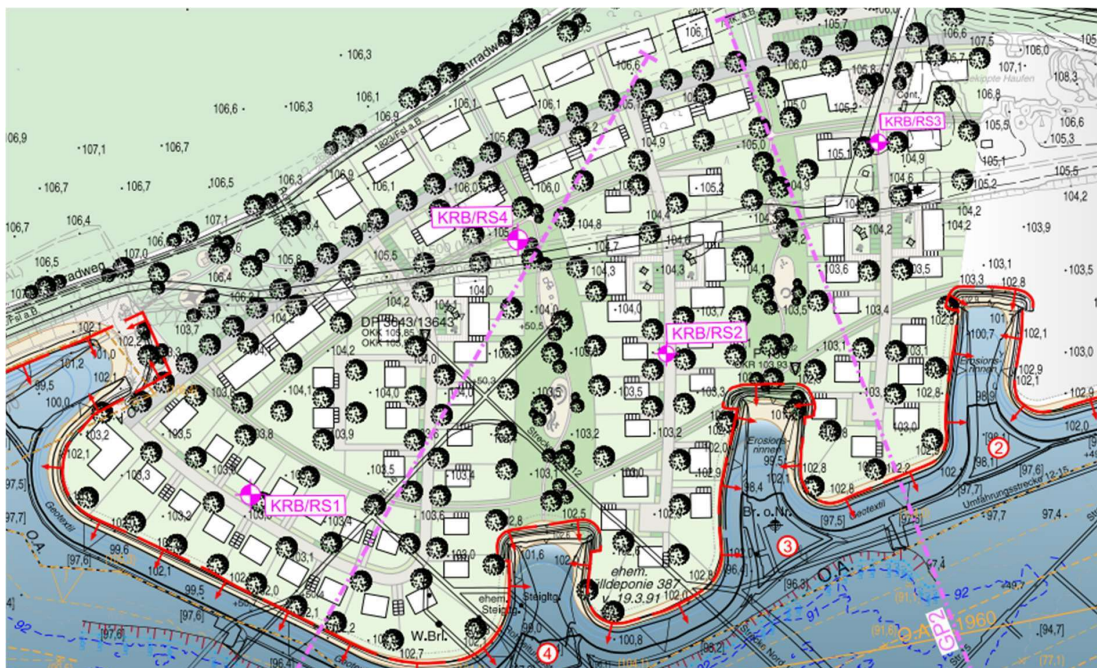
Ausschnitt Lageplan mit Baugrundaufschlüssen vom 24.06.2024 (GUB)
